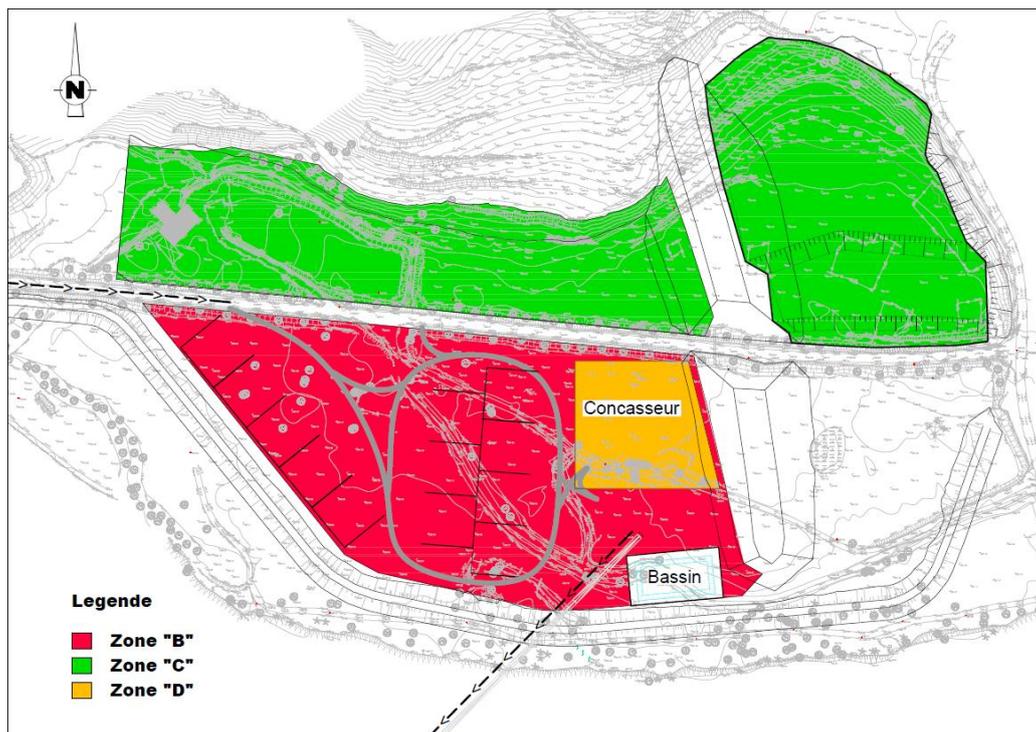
Plan de principe des installations, zonage de principe du site du Moulin pour le recueil et le traitement des eaux
